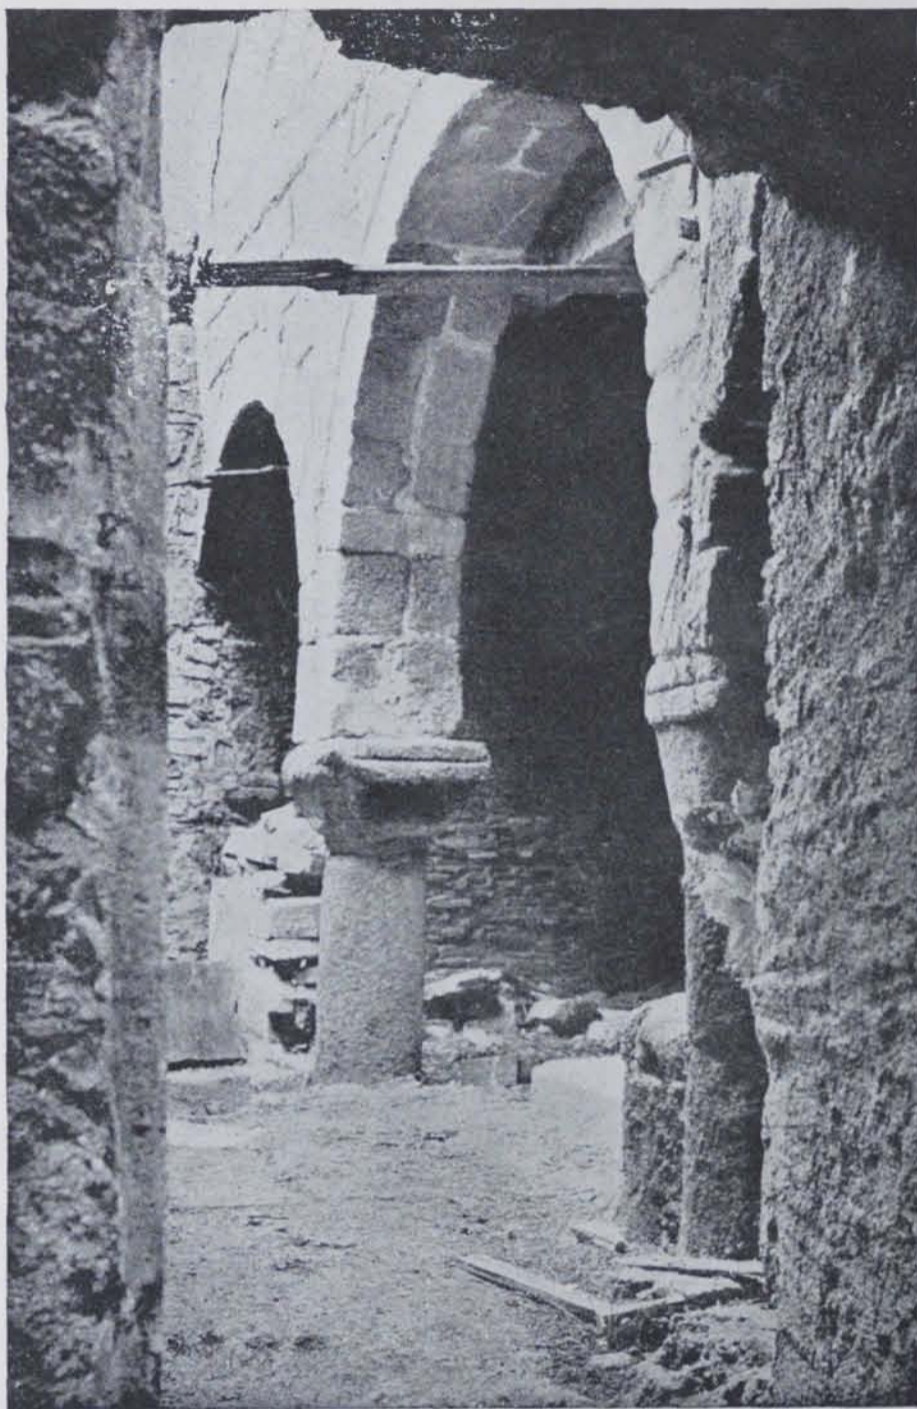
Sant Feliu de Guixols : Porta Ferrada. Detall abans de la restauració
